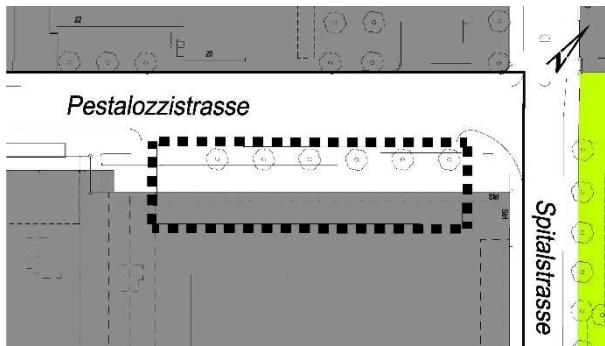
Plan-Nr. 14'285 / Zonenplan bestehend
